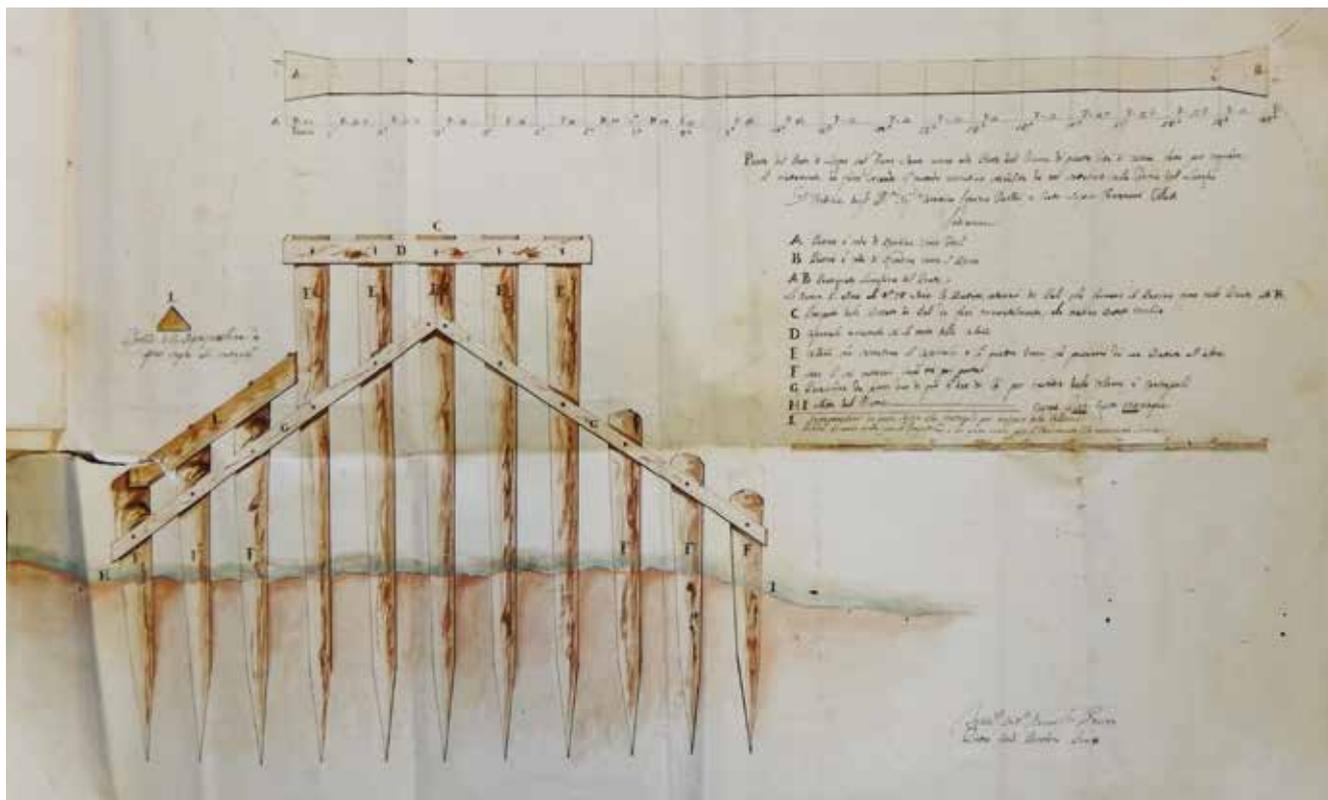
C.10 - ASce, Archivio Storico Comunale, b. 771, *Instrumenti d'Appalto di Ponti, Case, Strade e di Città, terrario e Cesenatico dell'anno 1743 per tutto il 1761*, c. 70r – Cesena, F. A. Brunelli, P. C. Borboni, *Pianta del Ponte di legno sul Fiume Savio vicino alla porta del Fiume di questa Città di Cesena, fatta per regolare il riattamento da farsi secondo il metodo esecutivo stabilito da noi sottoscritti sulla faccia del luogo d'ordine degli Ill.mi Sig.ri Canonico Ignazio Fabbri, e Conte Scipio Chiaramonti eletti*, pianta e prospetto (1745).
